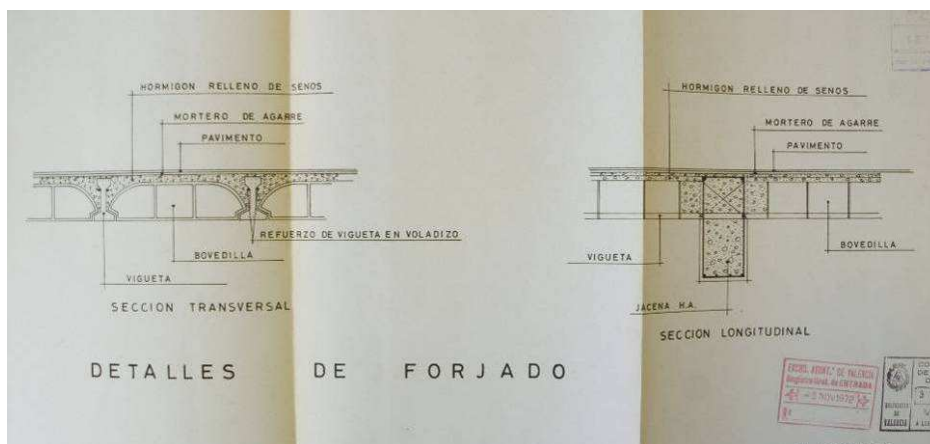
Detalle constructivo sección forjado. Edificio ficha 210C.020, 1972
